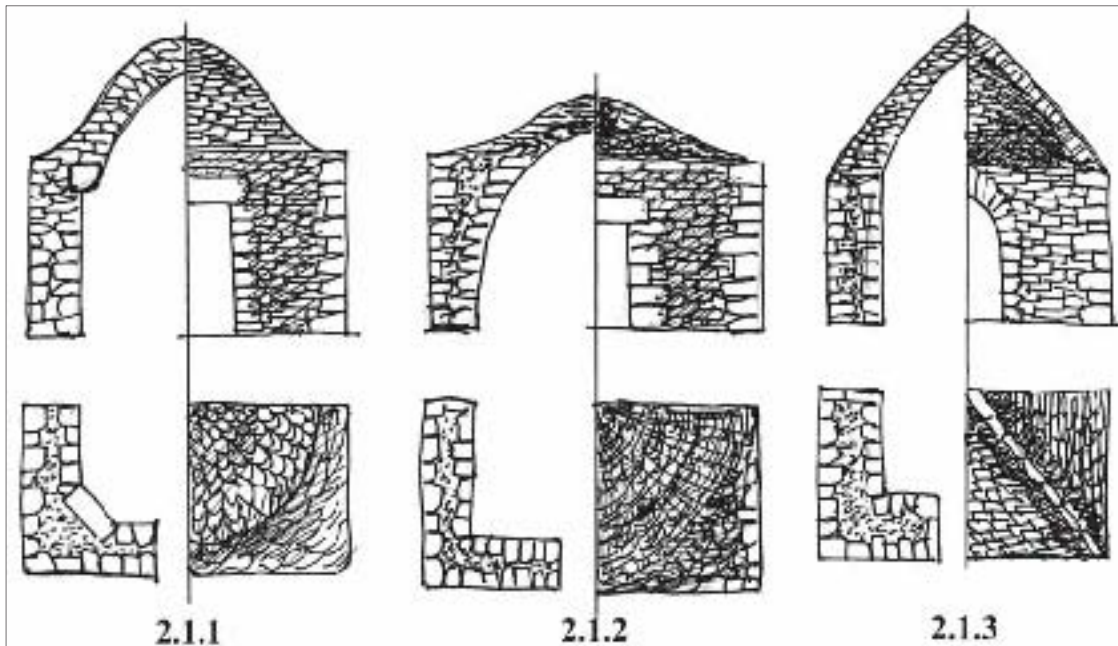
Construcciones de planta cuadrangular con cerramiento de cúpula.
